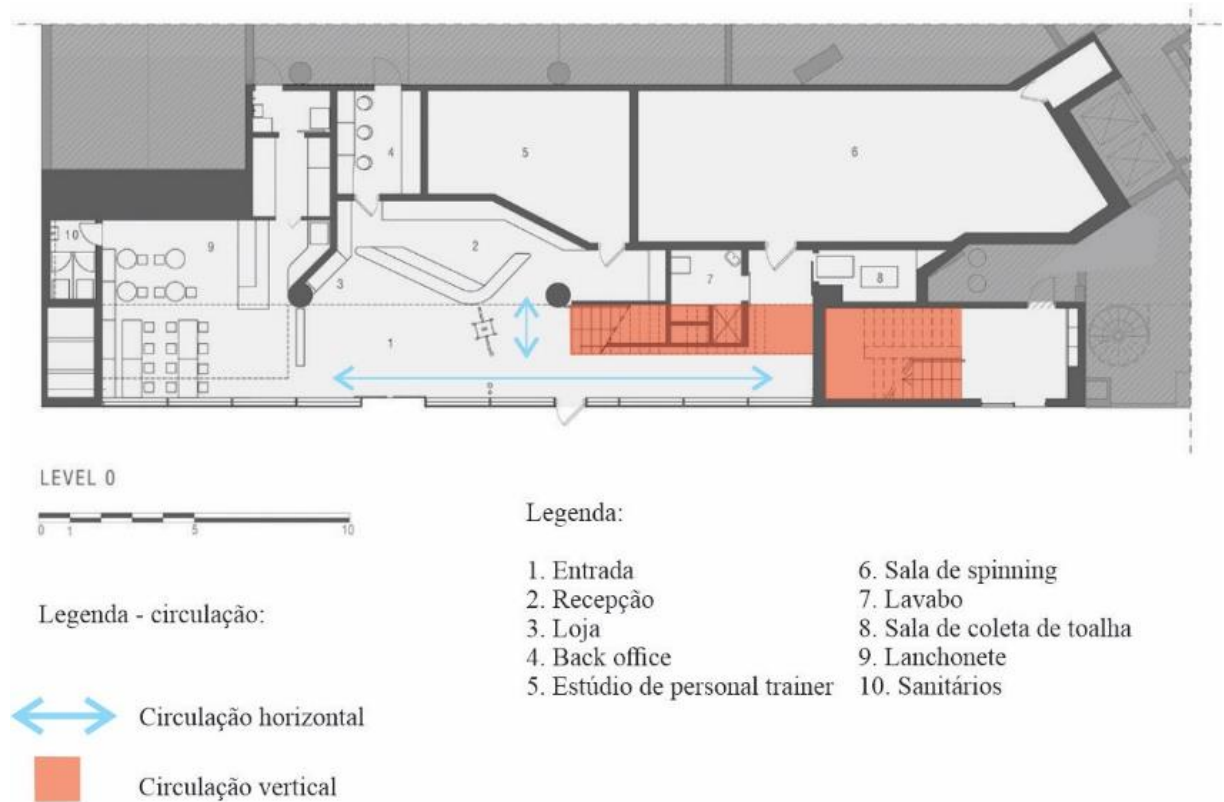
Planta baixa do térreo da Academia Pump com indicação da circulação. Fonte: Site Archdaily (2018).
